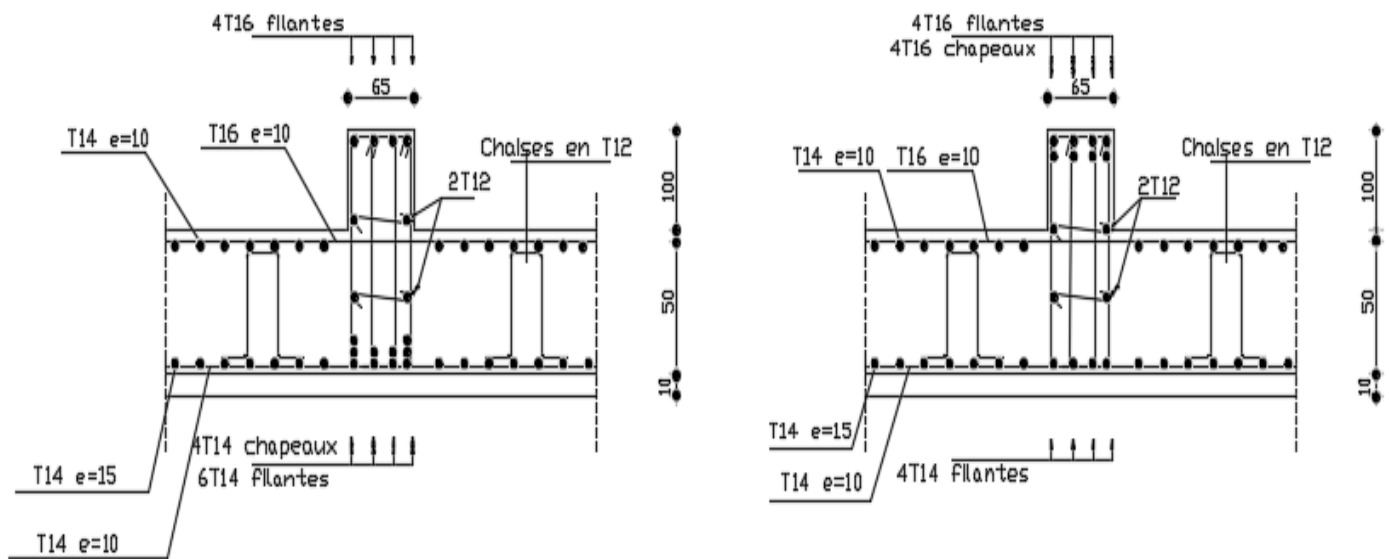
Ferrailage de la poutre secondaire en travée et en appui.
